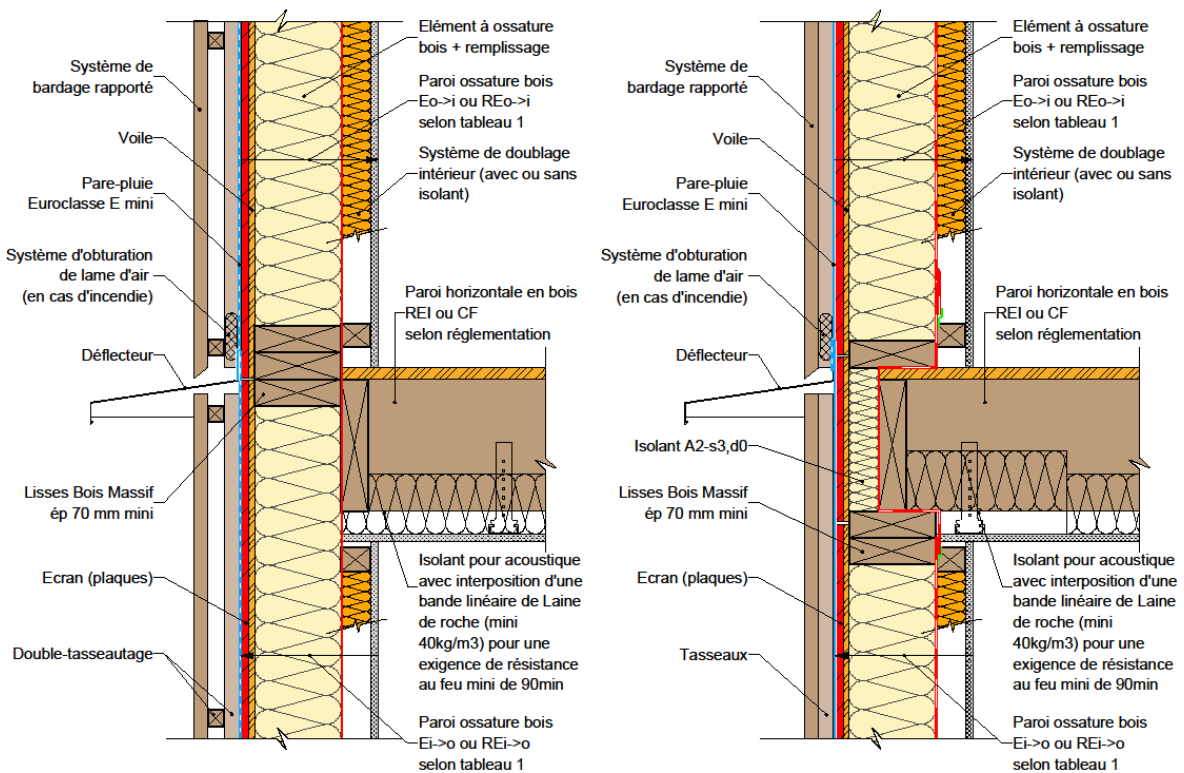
Façade/mur ossature bois & plancher en ossature bois.
